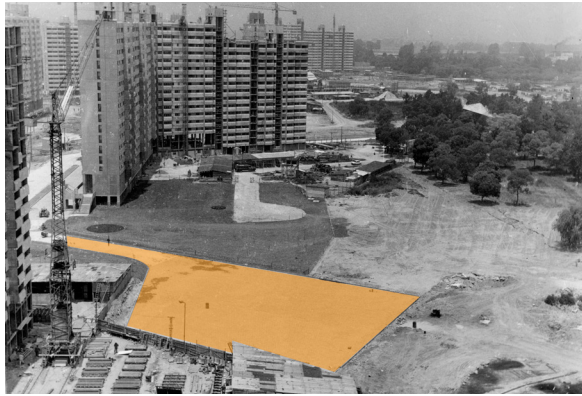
Lugano en obra. Playa de estacionamiento Fuente: Elaboración propia sobre imagen del Archivo General de la Nación
